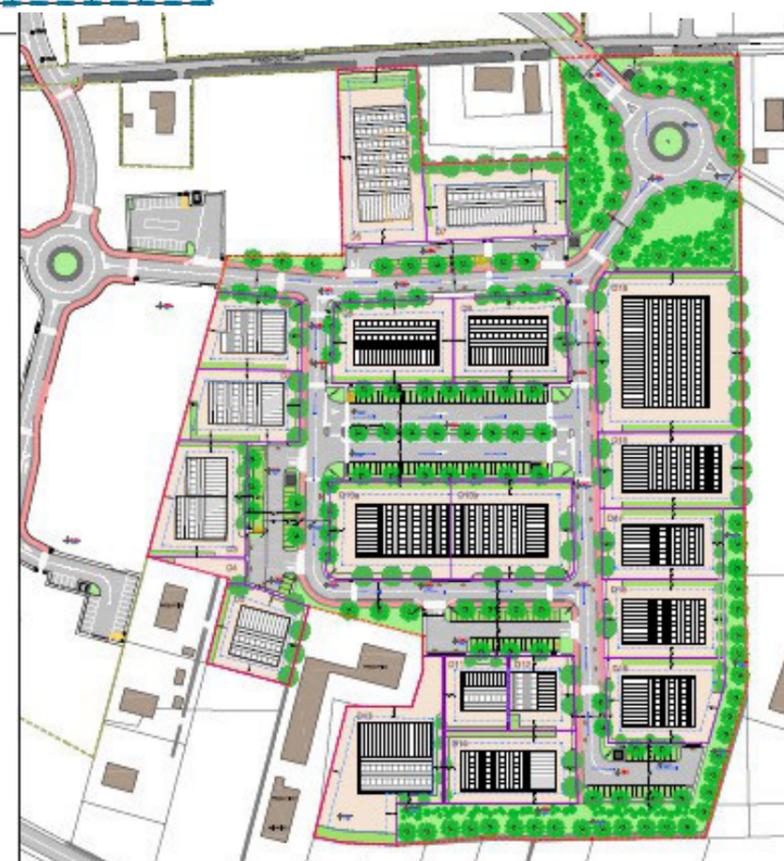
Planimetria generale - 2° Stralcio PUA Melatello
